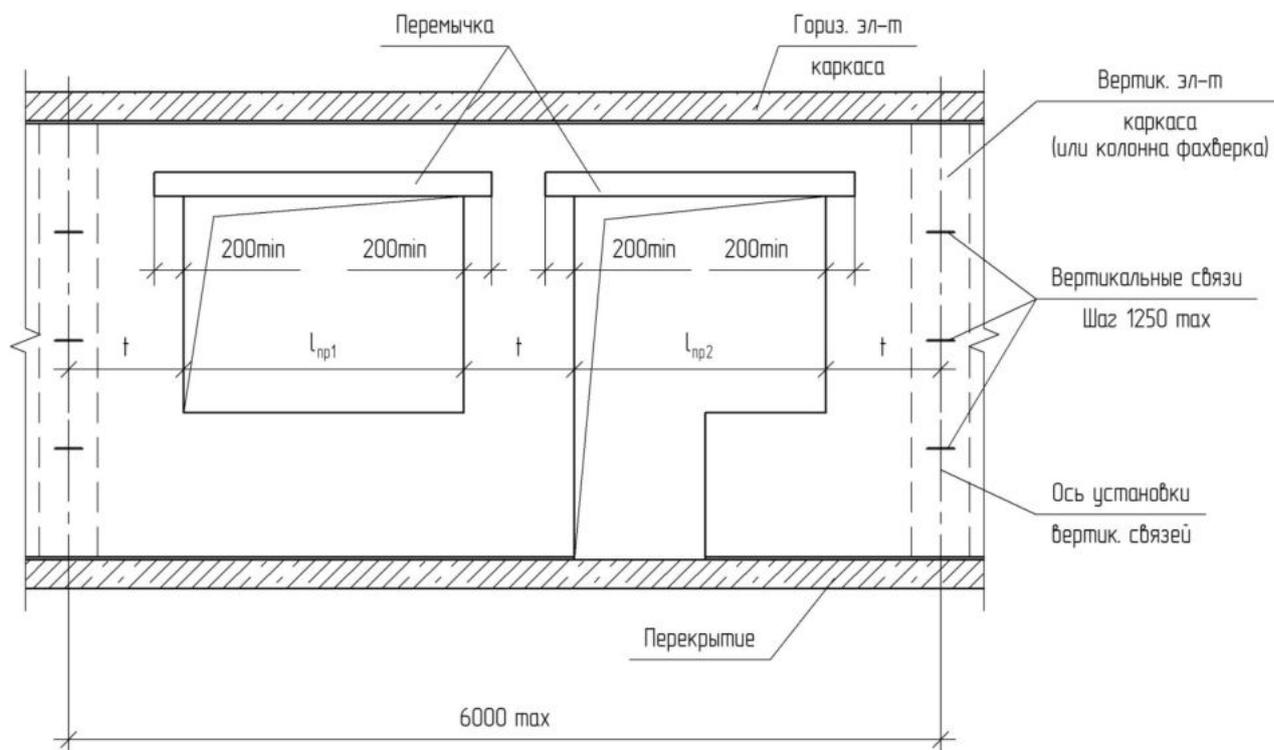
Схема устройства проемов на примере наружной стены
